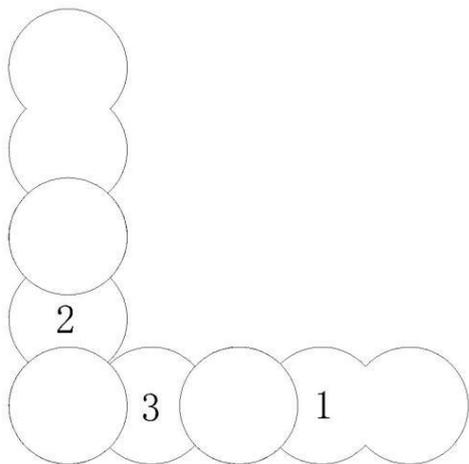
是三轴搅拌桩施工方法的转角施工顺序示意图；
